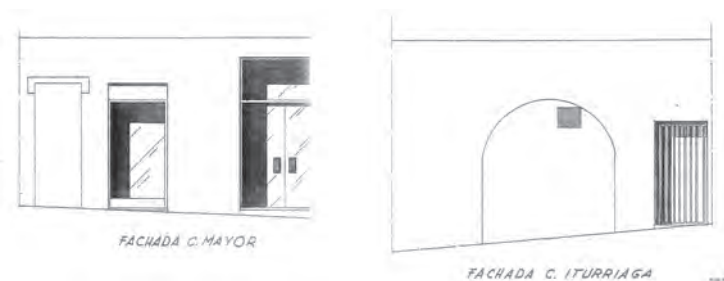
16. 1988 ALZADOS DE FACHADAS DE PLANTA BAJA A CALLE MAYOR Y A CALLE ITURRIAGA
